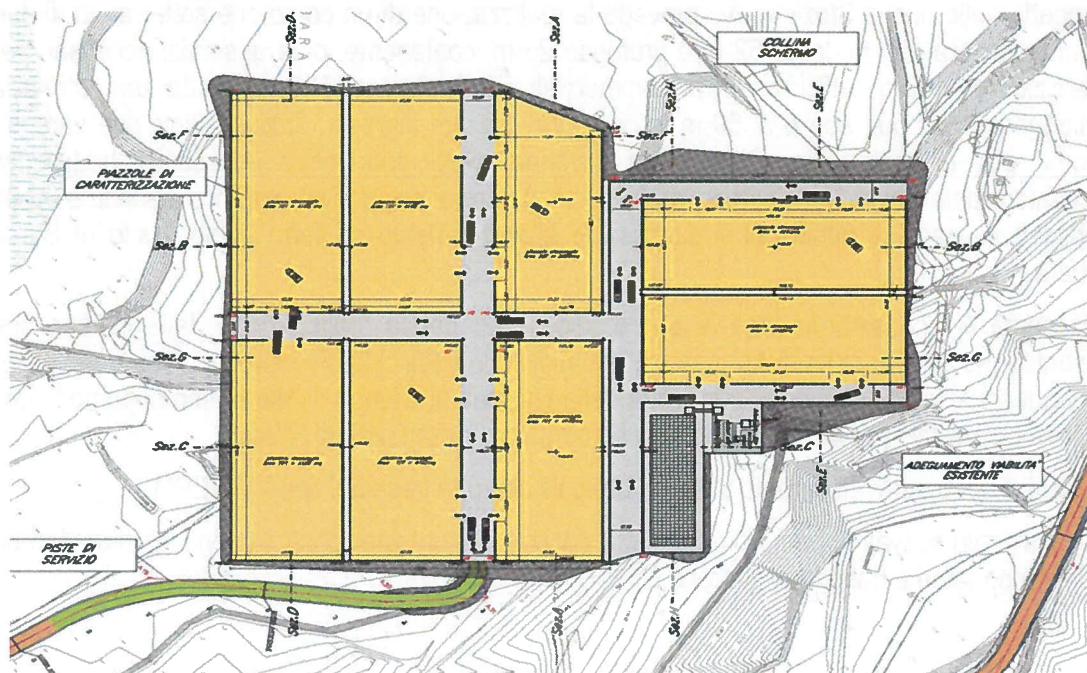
Planimetria delle piazzole del Sito di Santa Barbara
